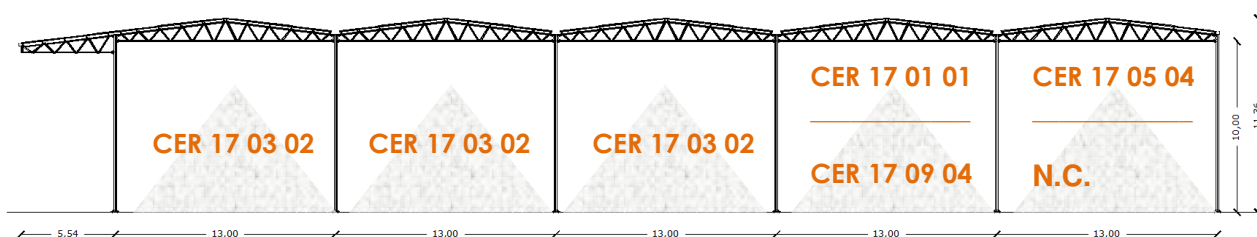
sezione pensilina 1 – schema dell'organizzazione interna della messa in riserva
